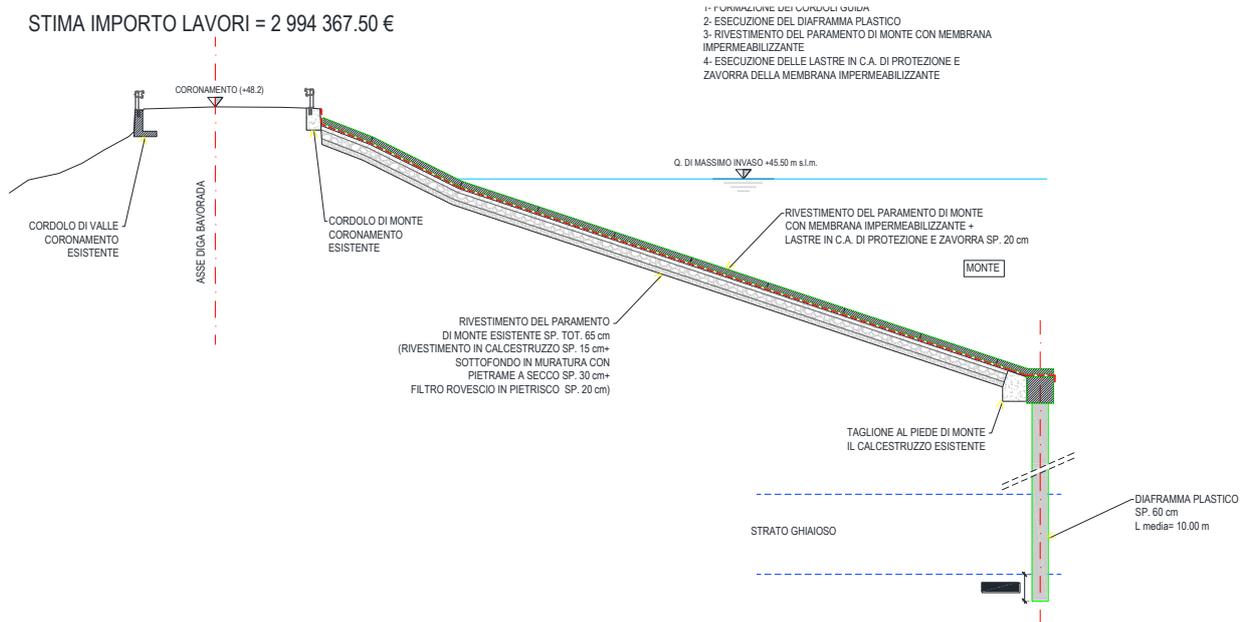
Impermeabilizzazione paramento di monte. Proposta intervento tipo 4.
